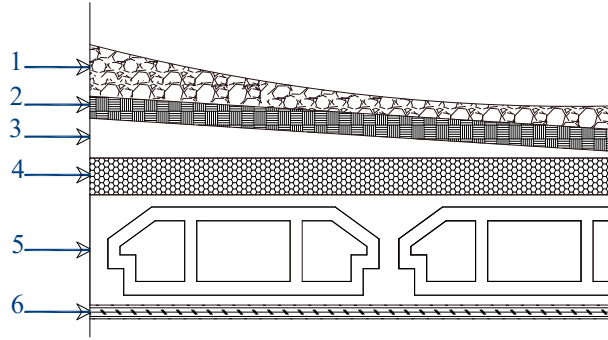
Coupe Transversale de plancher terrasse inaccessible (corps creux)
